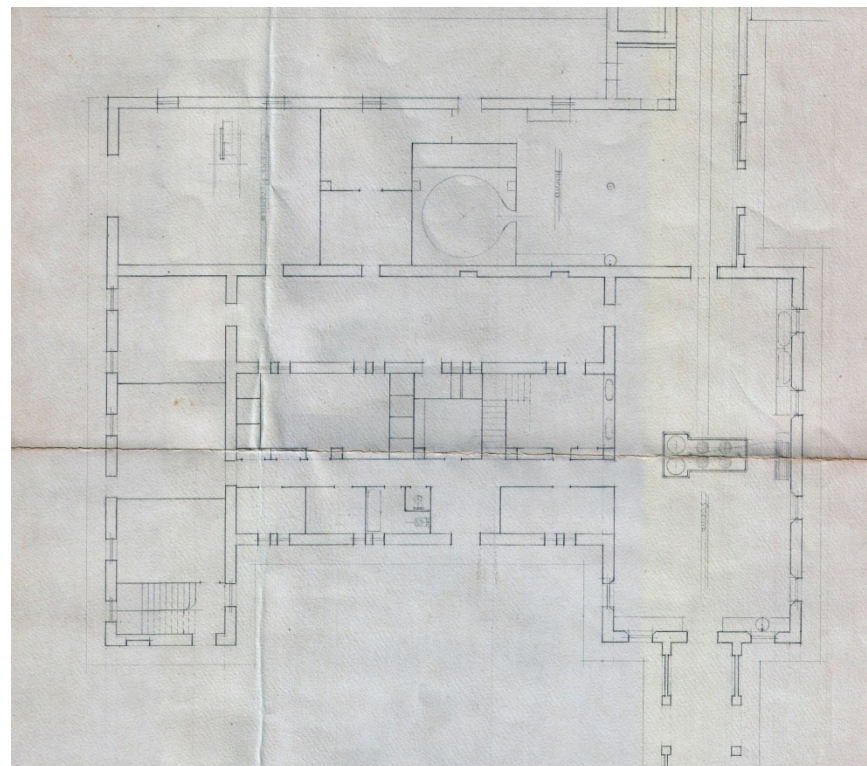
Plano distribución Pabellón de La Purísima, Horno de Pan y Serrería Mecánica. Año 1933. Arquitecto Juan Vidal.<sup>144</sup>
